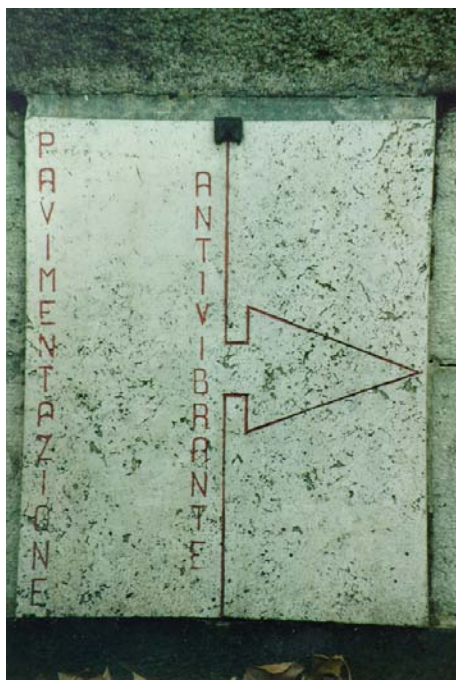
Inizio del tratto di pavimentazione antivibrante sul Lungotevere
